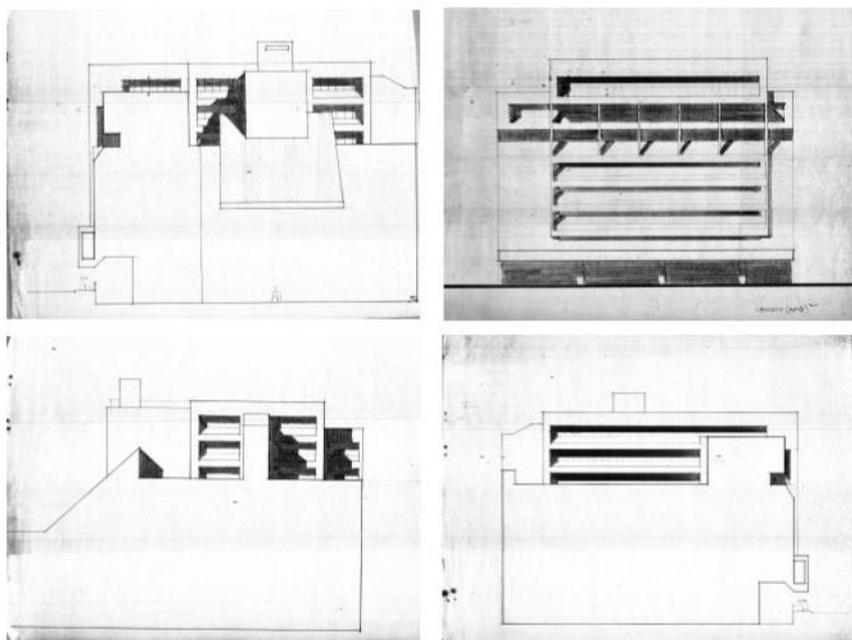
Croquis de fachada norte, sur, este y oeste del Omni (ensamble de fachadas)
